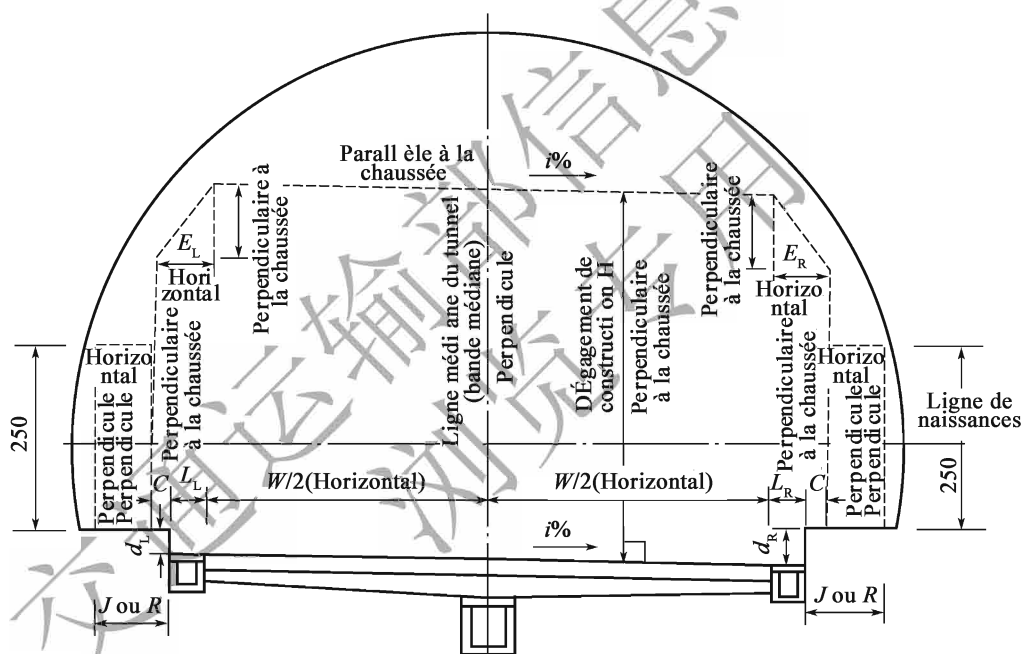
Situation de base du dégagement de construction du tunnel (unité : cm)
